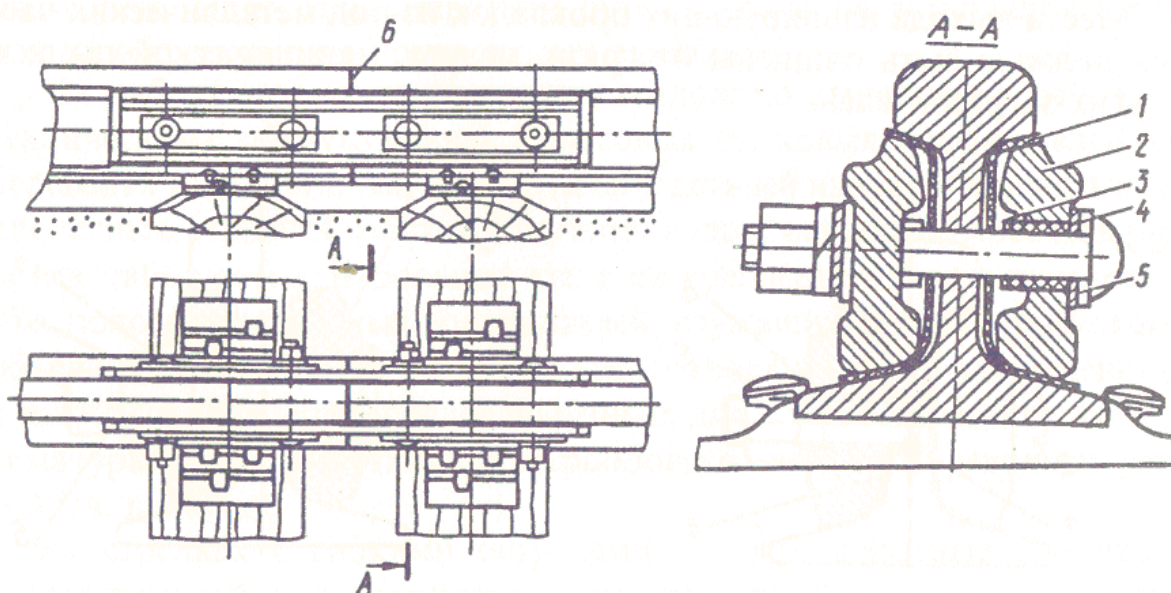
Изолирующий стык с двухголовыми металлическими накладками для пути с деревянными шпалами:
